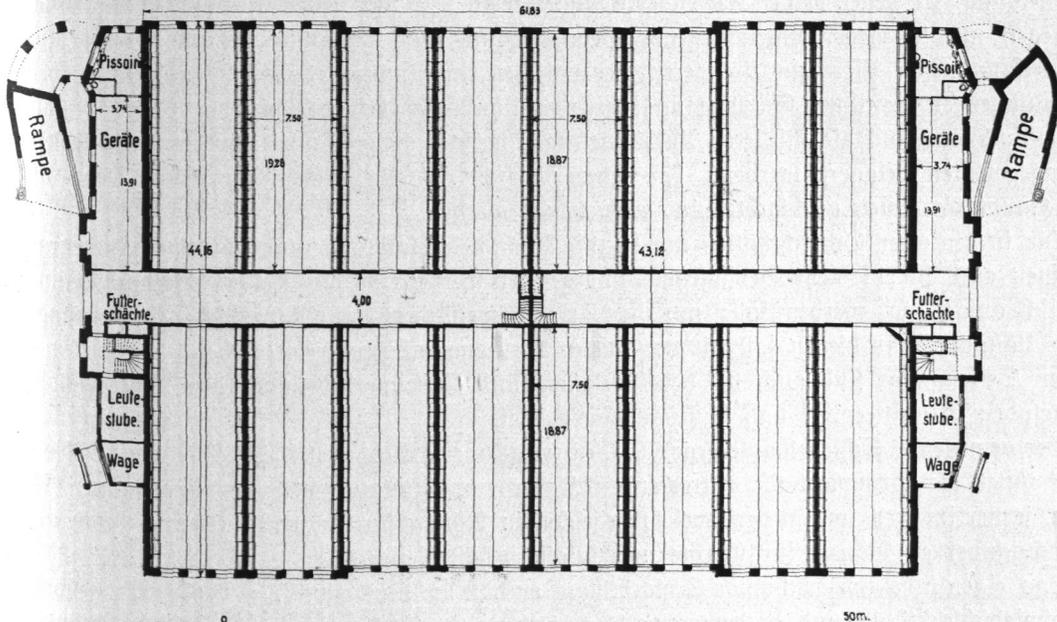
Zentralviehmarkt, Stallgebäude für Rinder, Grundriß.
